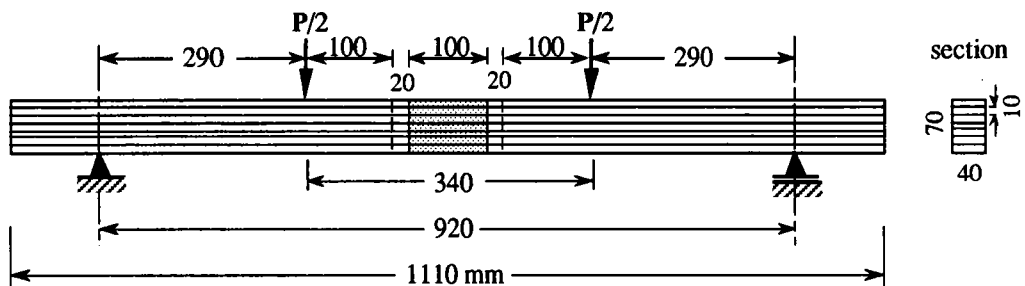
Géométrie et schéma d'essai des poutres sous assemblage aligné.
